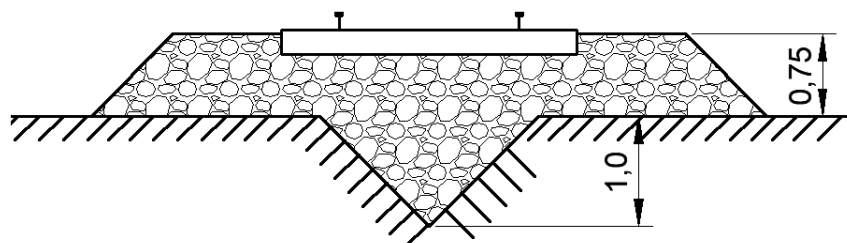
Бесполостная дрена треугольного поперечного сечения
